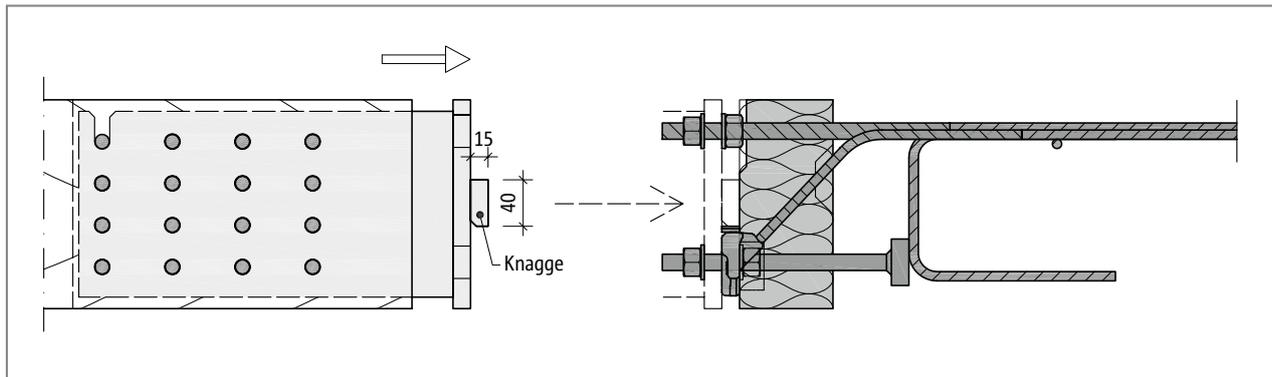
Schöck Isokorb® T Typ SK mit Stahlschwert: Anschluss des Holzträgers
